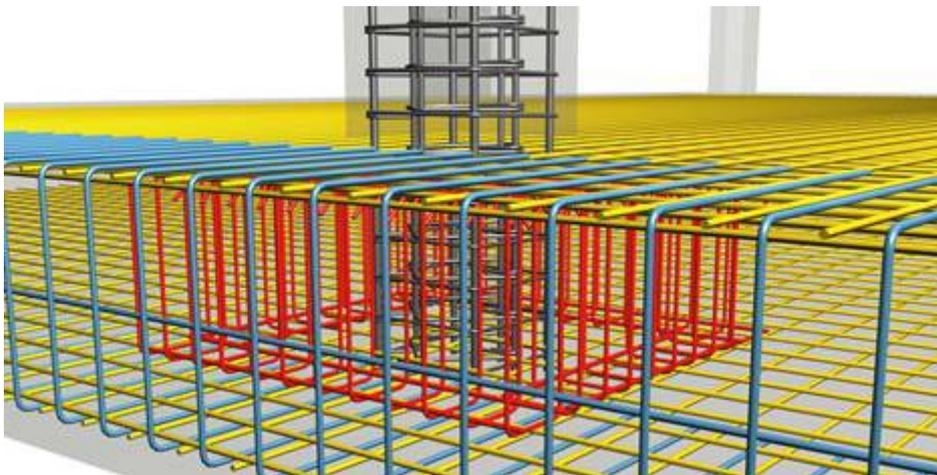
Розкладка арматури, що протидіє продаванню, в ростверку фундаменту під колоною, відображена у Tekla Structures
